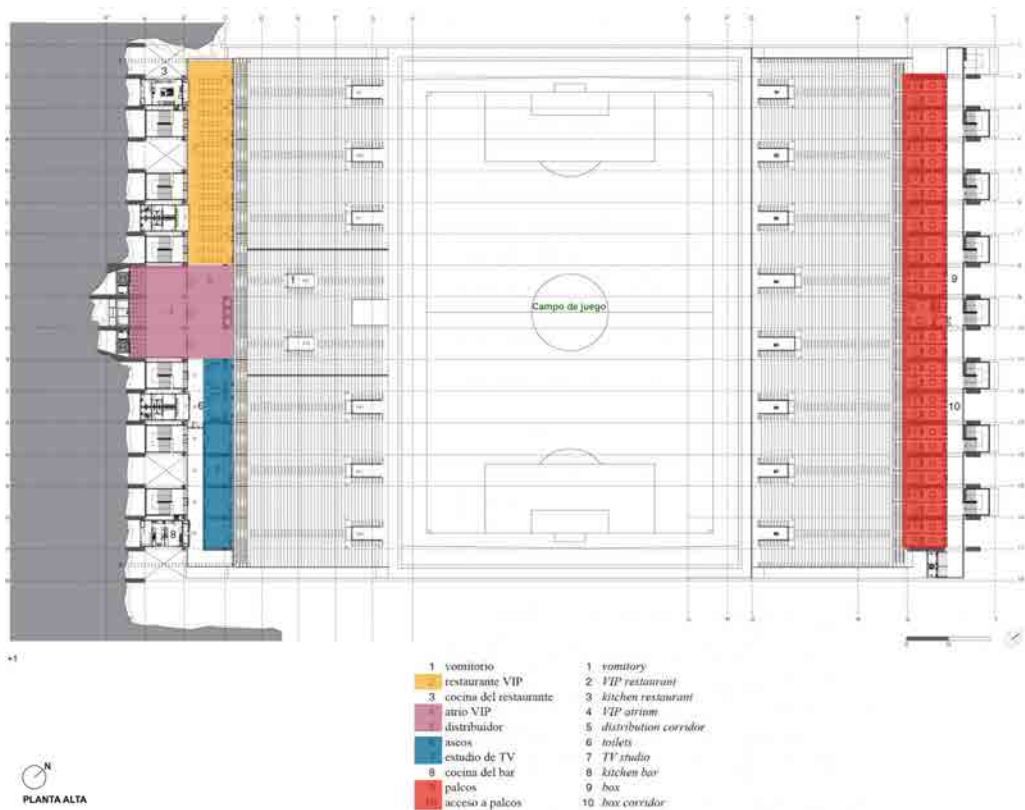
Programa Planta Alta. Fuente: www.arquitecturaviva.com. Elaboración: Autores.
